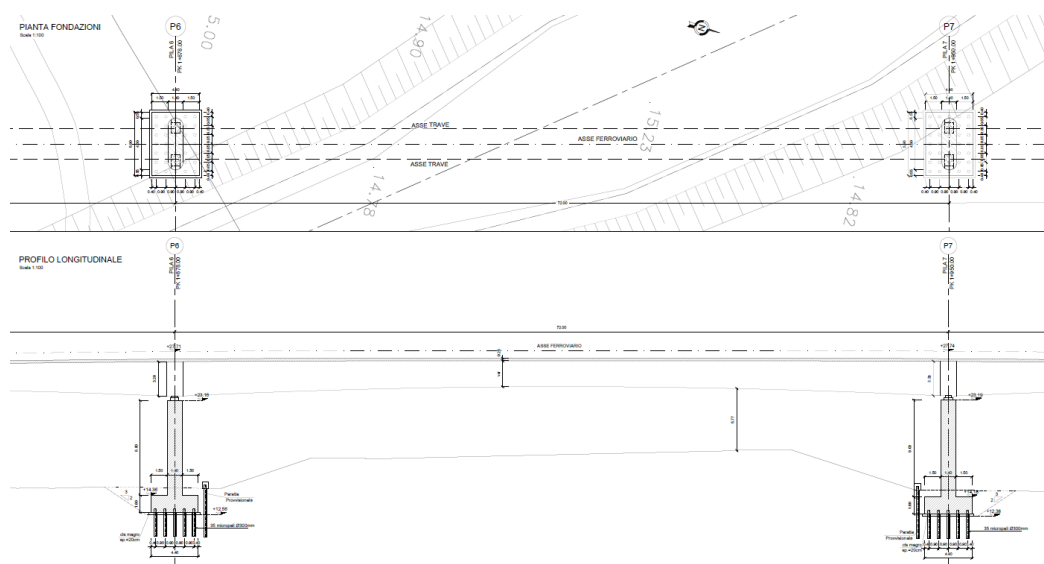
Stralcio pianta fondazioni e profilo longitudinale (campata 7)
